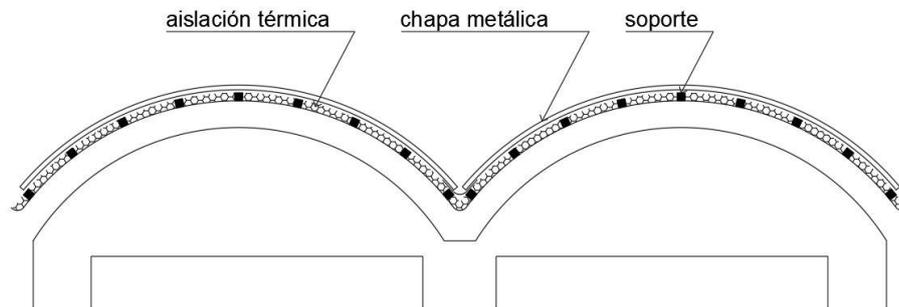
Corte esquemático propuesta aislación de cubierta.
